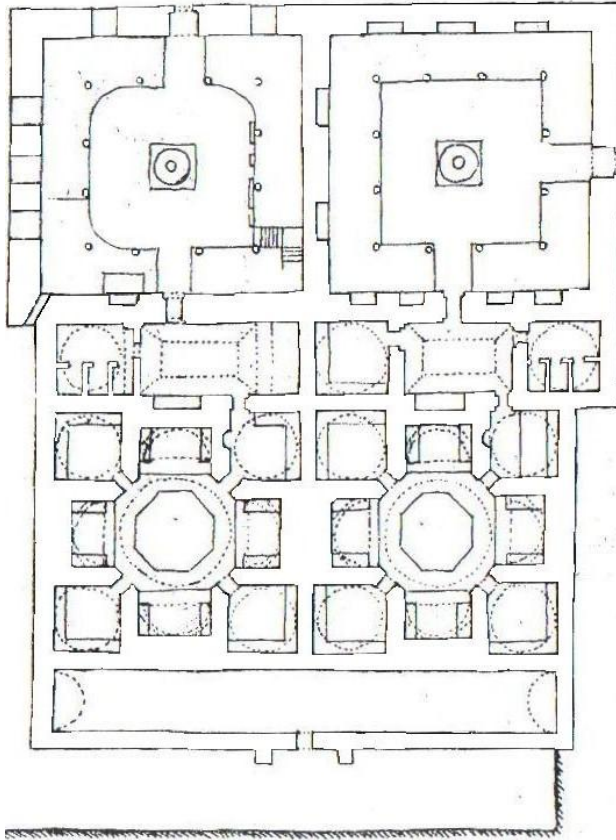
Eski-Yeni Hamam (Tire) plan şeması
